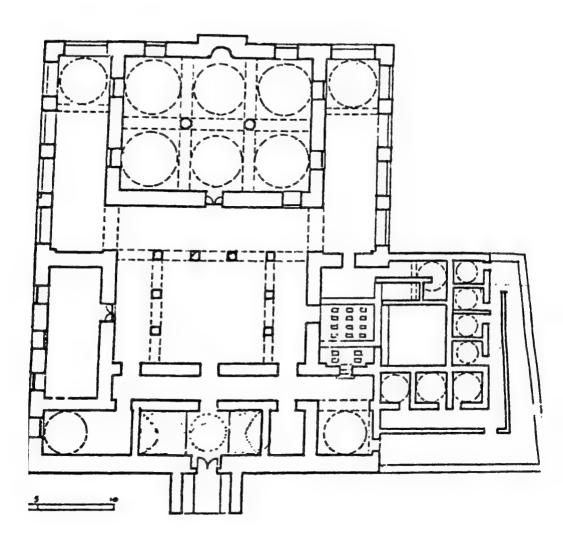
مسقط أفتي للمدرسة الأشرفية _ تمز الطابق الأول _ الطابق الثاني
